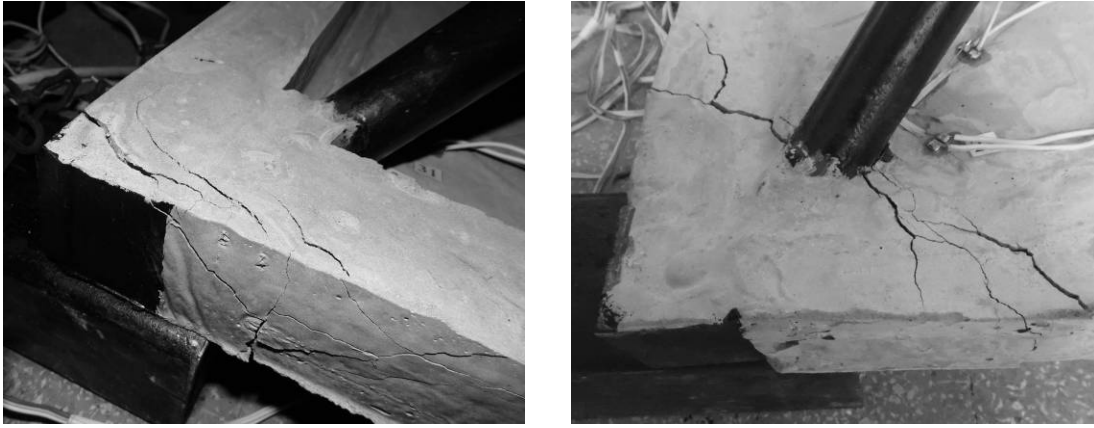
Руйнування опорних зон армоцементної і залізобетонної плит
